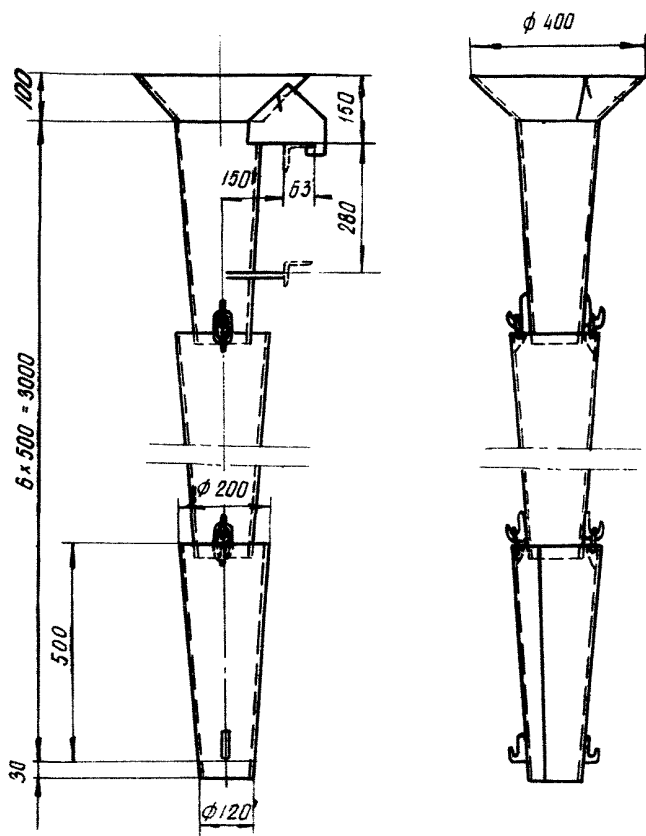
Металлический хобот для укладки бетона в отдельные захваты вертикального стила
